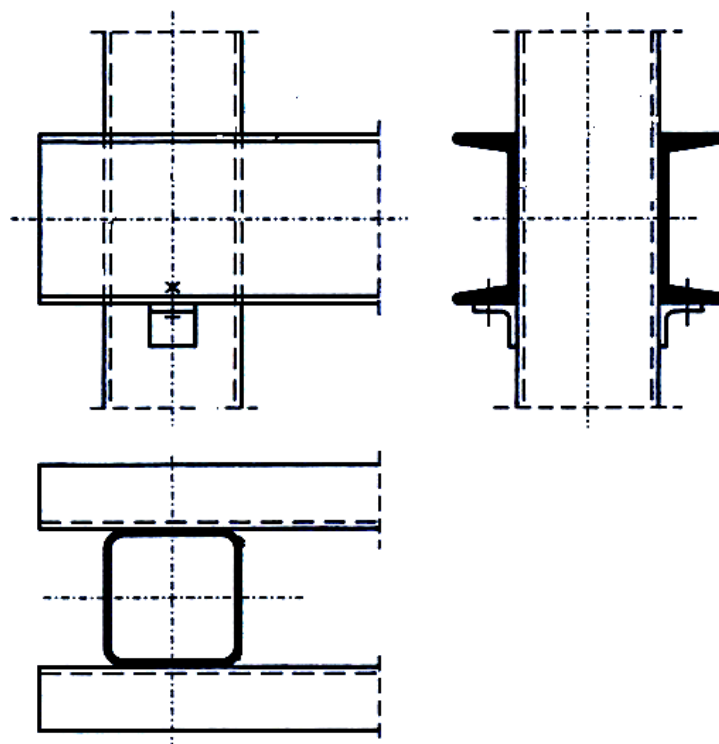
Сварное сопряжение двухветвевых ригелей из швеллеров с трубобетонной колонной коробчатого сечения [8]
